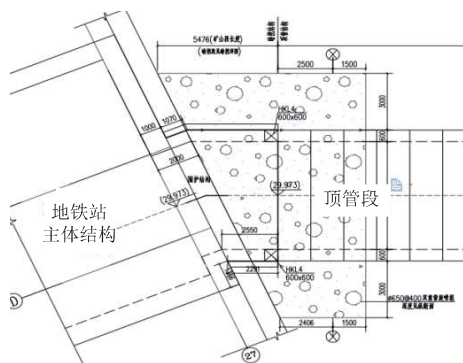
矩形顶管接收端与暗挖段连接处平面布置图(单位:mm)
